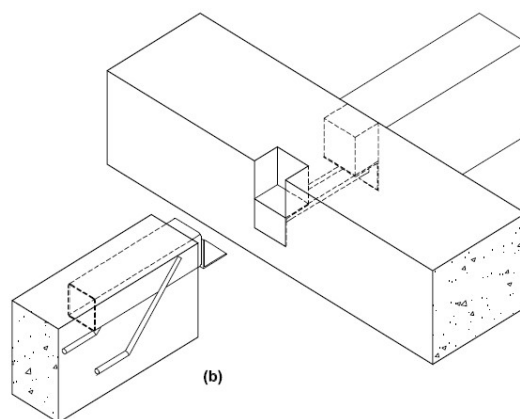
Ligação com armaduras em gancho (PCI, 2004)
